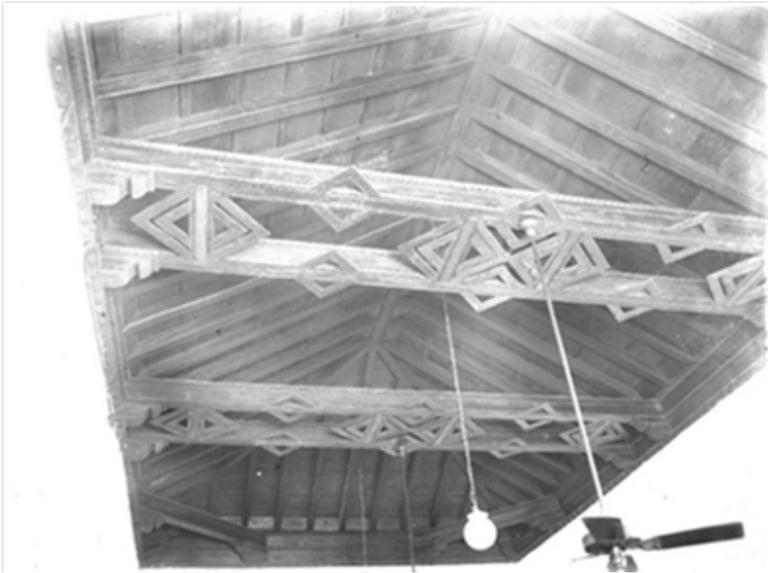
Detalhe do teto do Convento de Santa Clara
